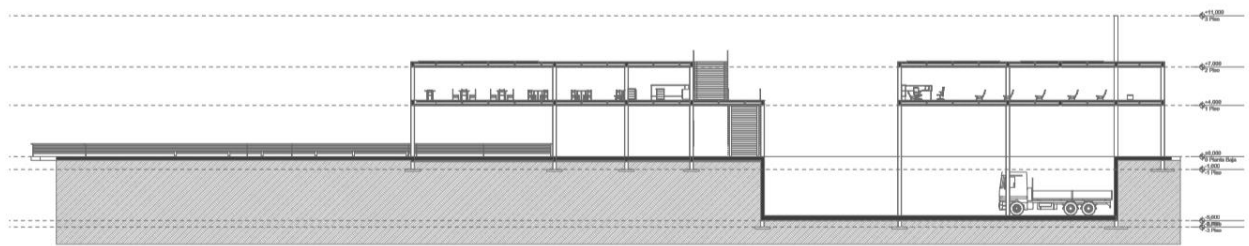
Corte A-B arquitectónico (Sanchez J. D., 2018)
